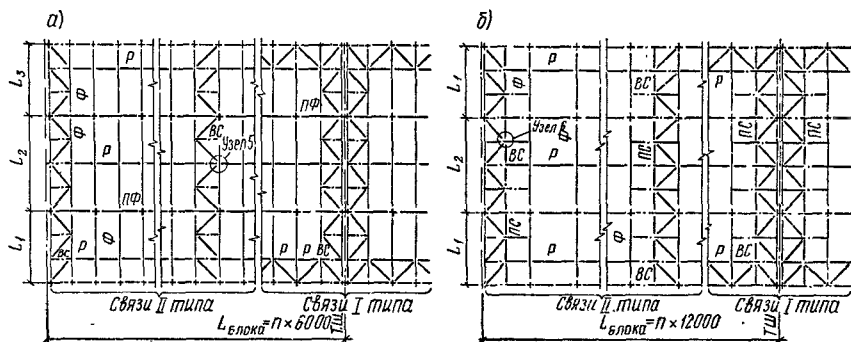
Схемы расположения элементов конструкций покрытия в уровне нижних поясов ферм а — при шаге ферм 6 м; б — то же, 12 м; ПС — дополнительный пояс связи (остальные обозначения см. подпись к рис. 11.1; узлы 5 и 6 см. на рис. 11.20 и 11.21)
